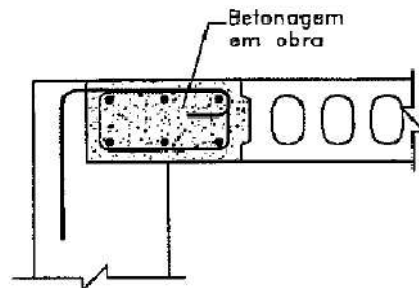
Ligação laje com uma viga adjacente ao vão (adaptada de [46])
